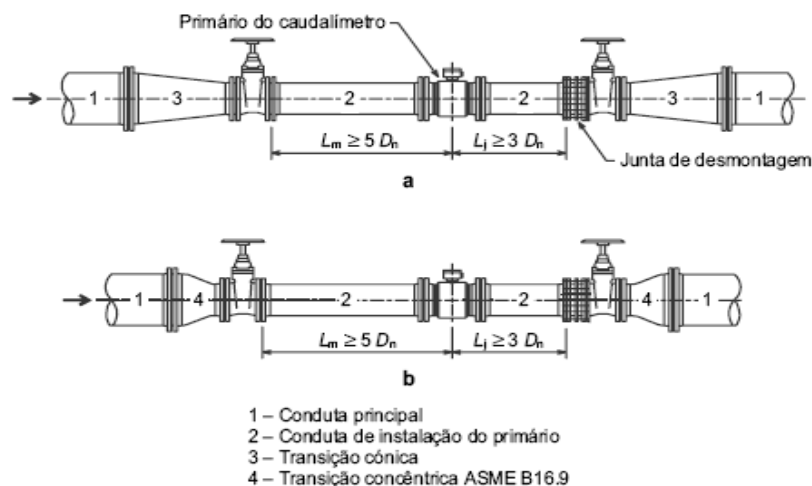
Instalação do primário de um caudalímetro eletromagnético o tubular com utilização unidirecional: comprimentos retos de conduta a montante e a jusante do primário e transições entre a conduta principal e a conduta de instalação.
